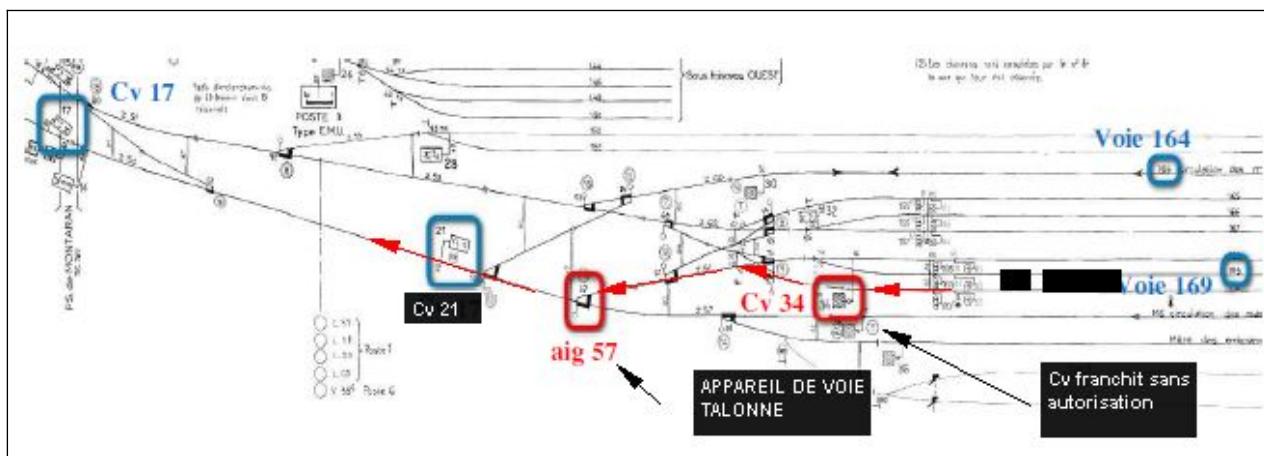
Dépassement du point d'arrêt – Plan technique (Source SNCF Réseau)
